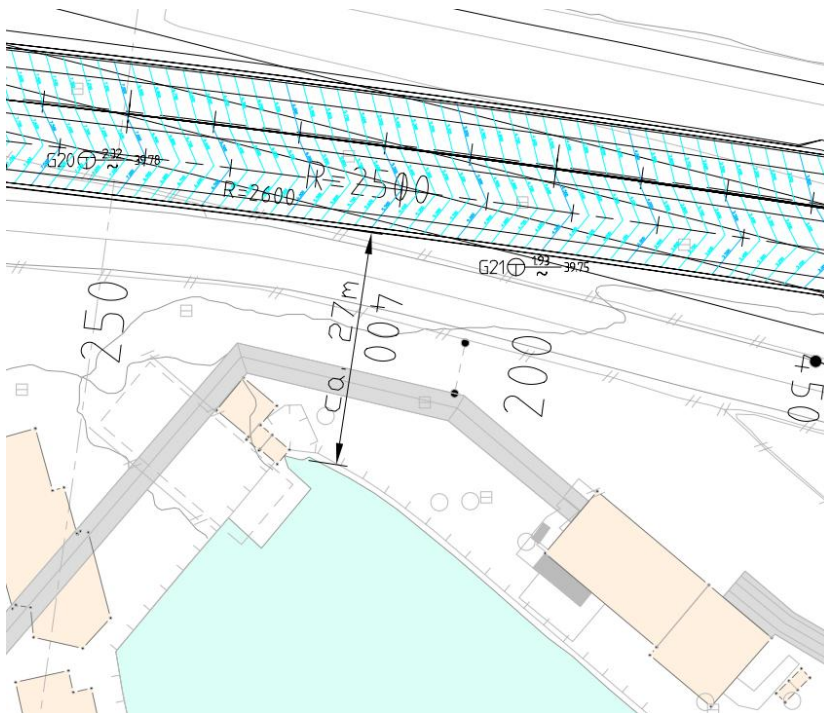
viser østre påløpsfylling for planlagt bru over jernbanen
